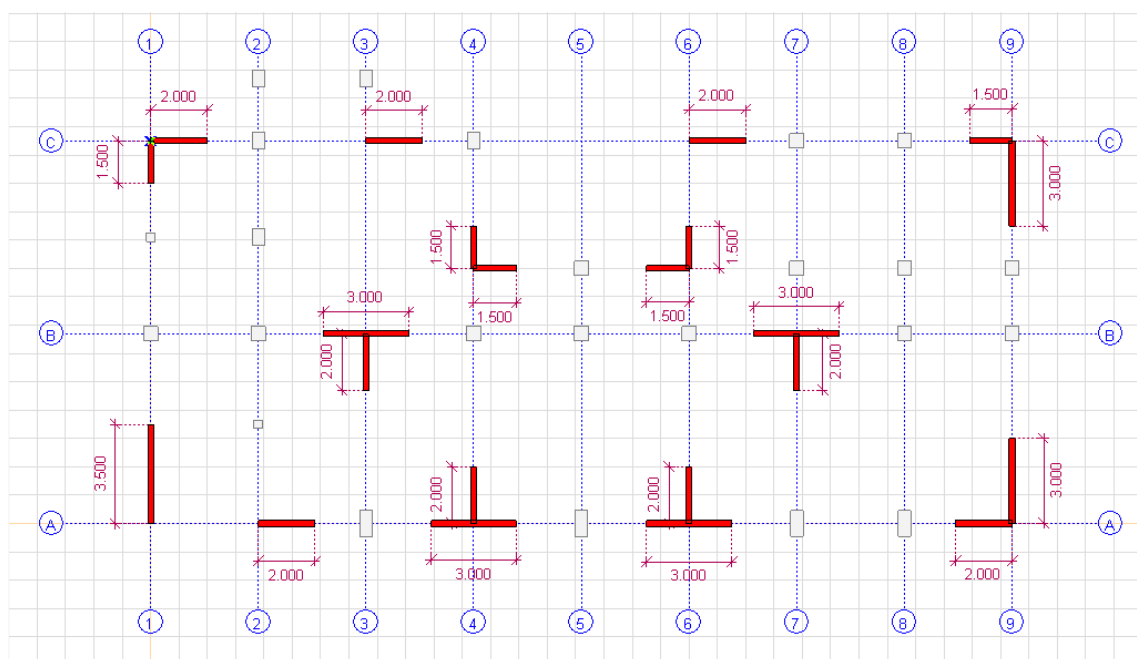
Plan de principiu pentru dispunerea noilor pereți structurali
